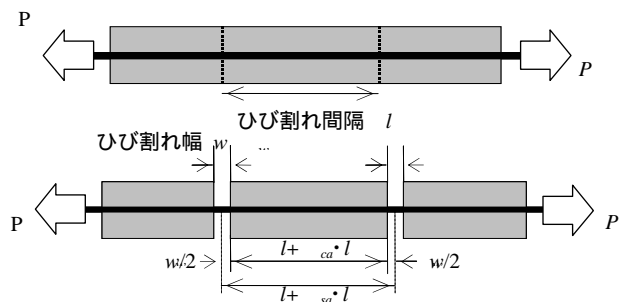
鉄筋コンクリート部材のひび割れ幅
